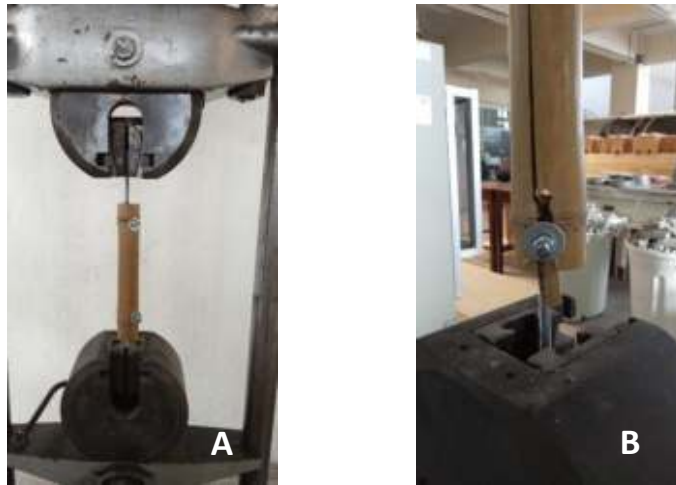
Dispositivo a tracción del dispositivo 4. a) Pieza sin deformación inferior y superior, b) Detalle con deformación inferior, desplazamiento de paredes de culmo.
